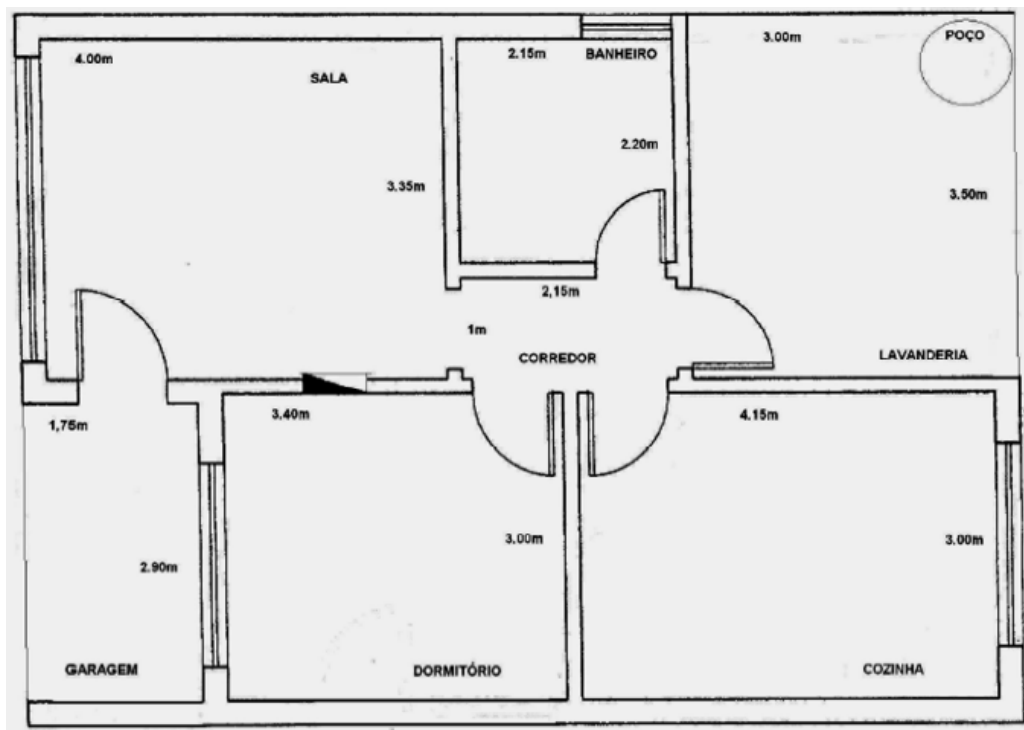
Ilustração de uma Planta Baixa de uma Residência.
